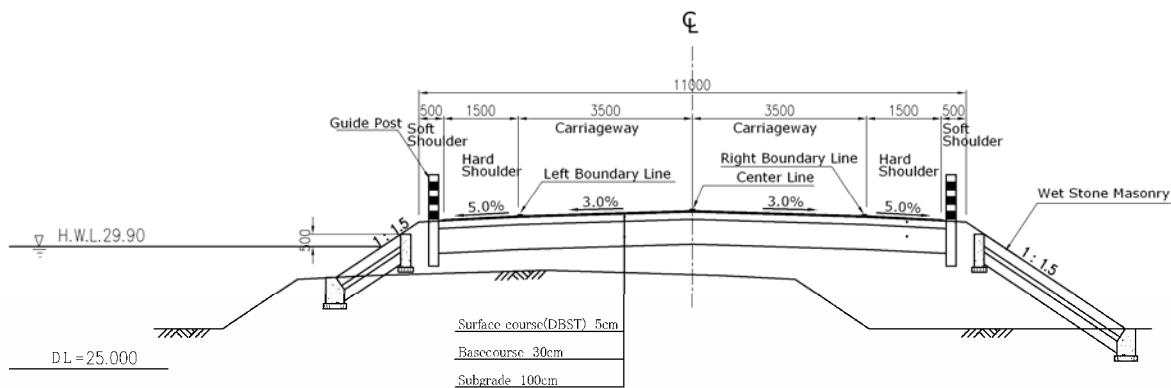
Profil en travers-type de la voie d'accès au pont Fanyé
